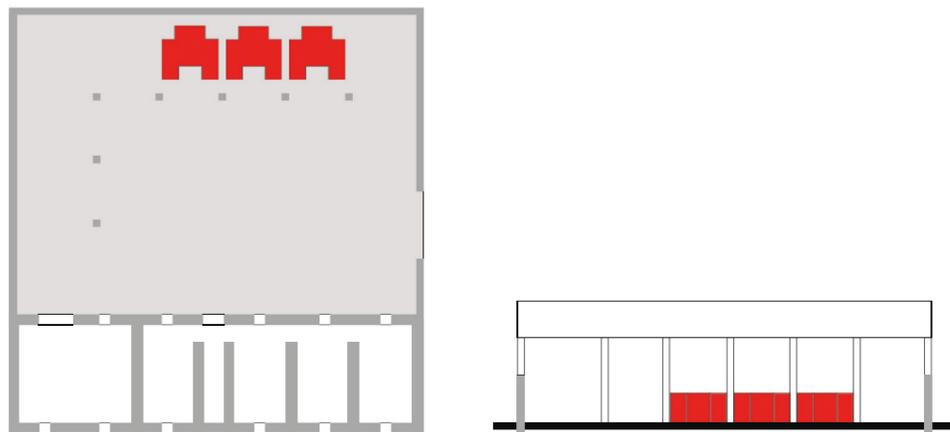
Schemi di collocazione in pianta e in prospetto del Modulo Abitativo MAACC all'interno delle cascine con destinazione d'uso agricola, fonte: elaborazione immagine dell'autore
